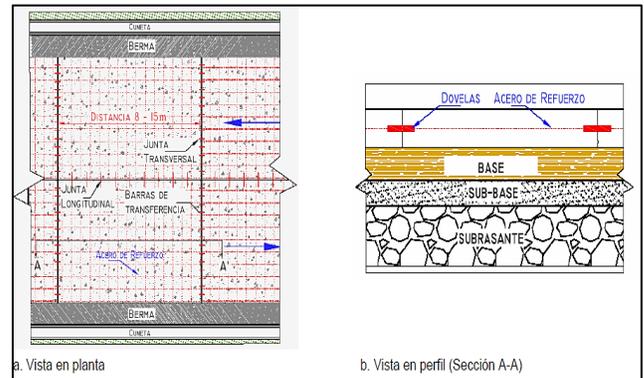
Pavimento Rígido con Juntas Reforzadas (INVIAS, 2006).
